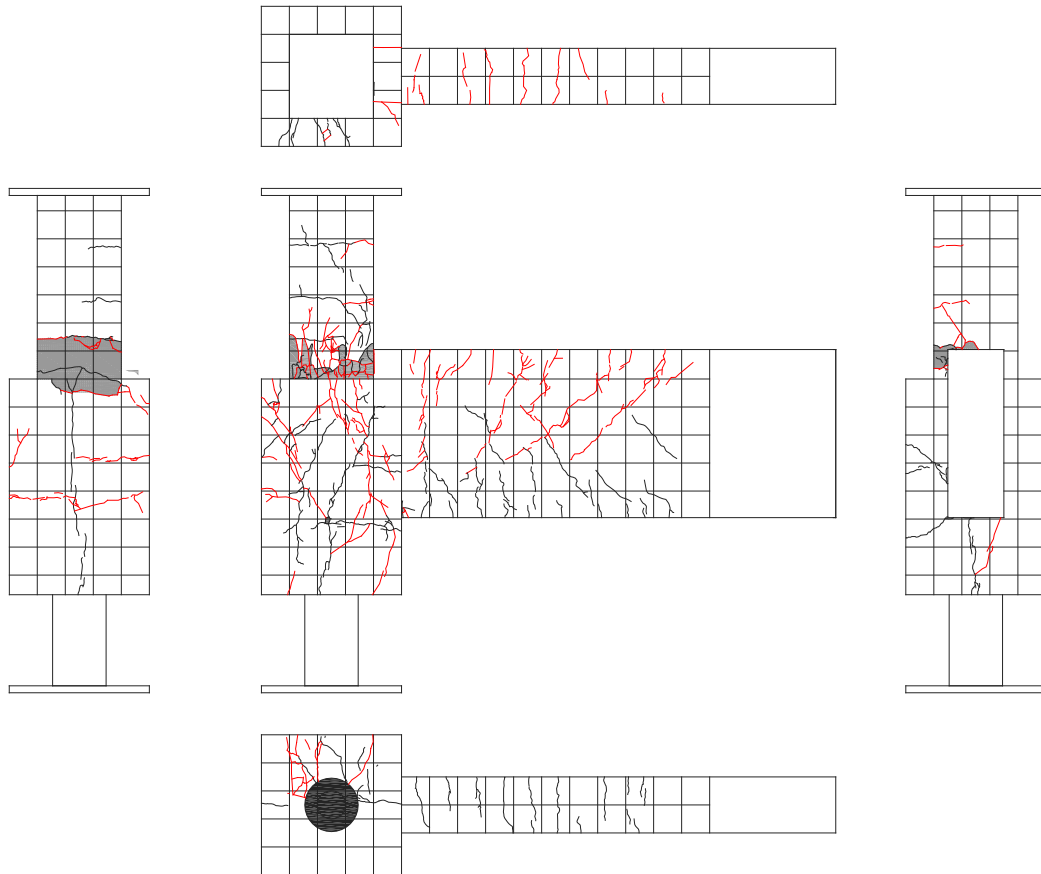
試験体 A-5 ひび割れ状況 (9Cycle)
